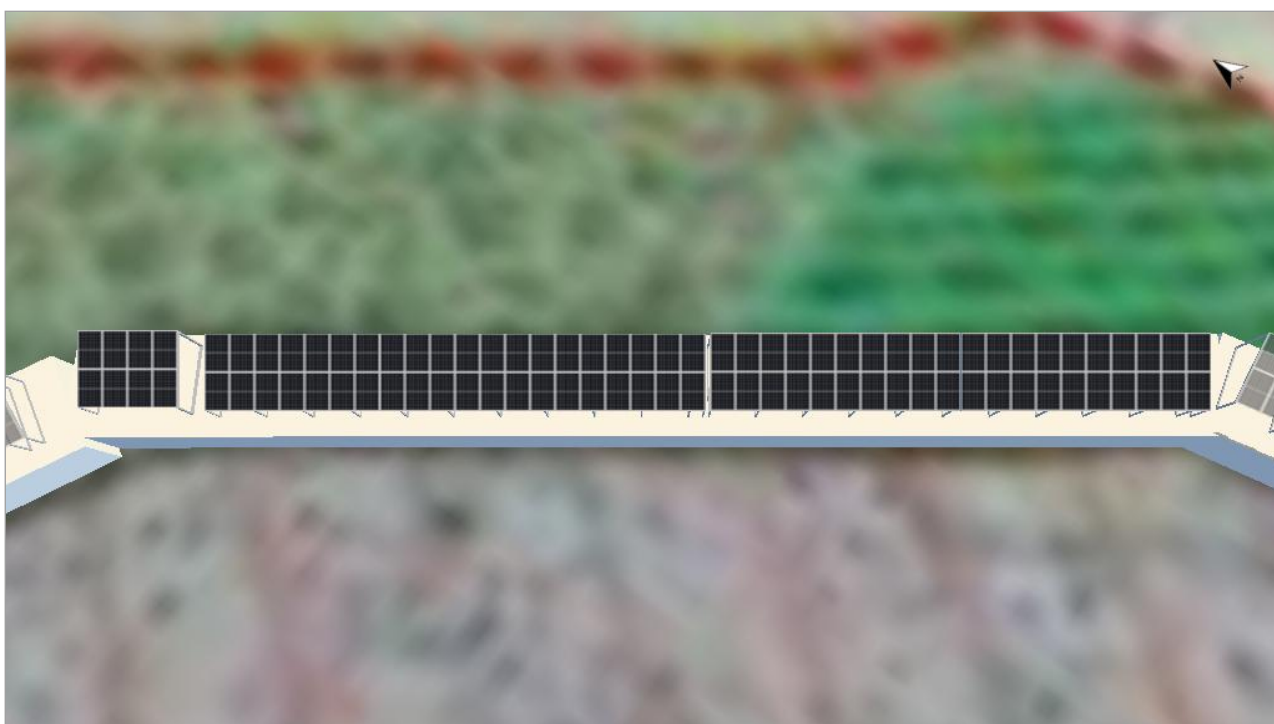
Modulfläche - Gebäude 08-Dachfläche Südwest
